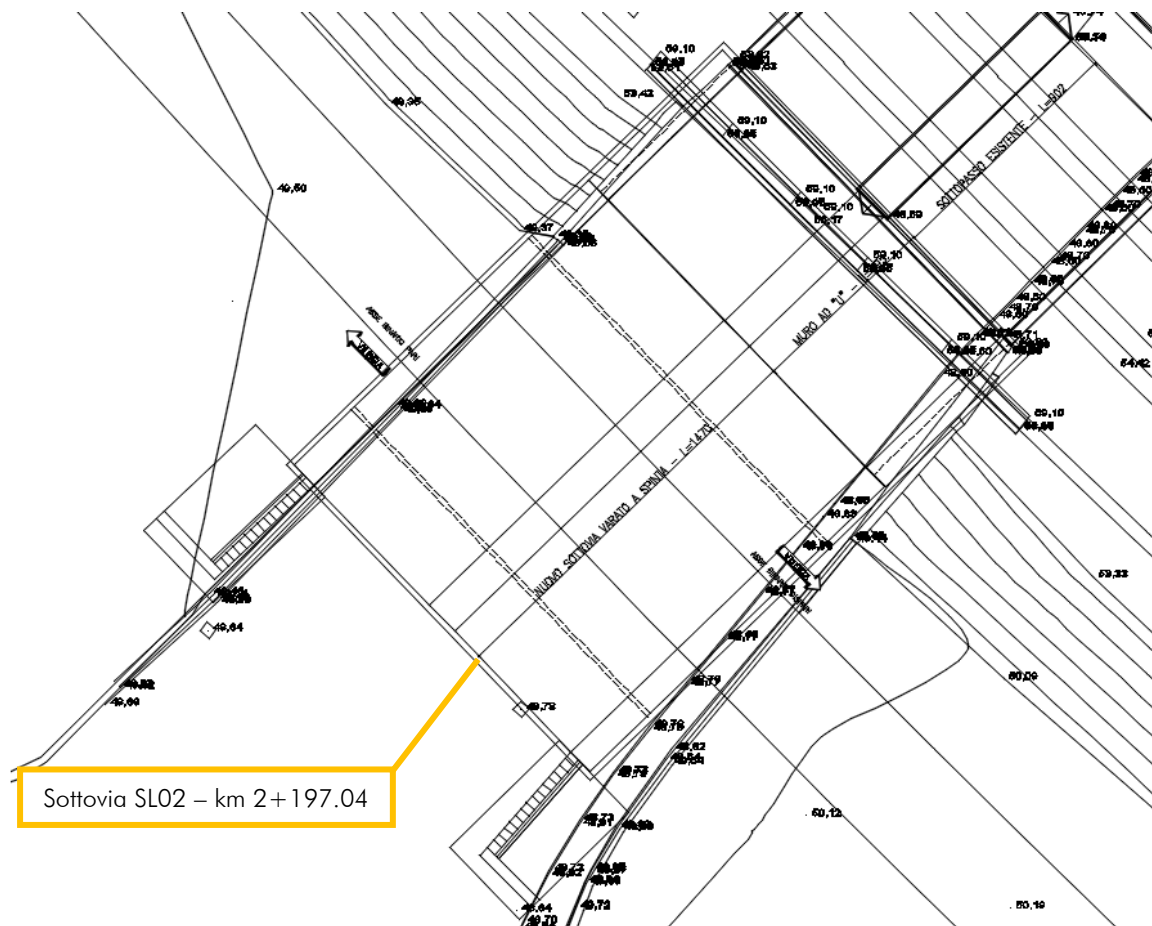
Stralcio planimetrico – Ubicazione Sottovia SL02
